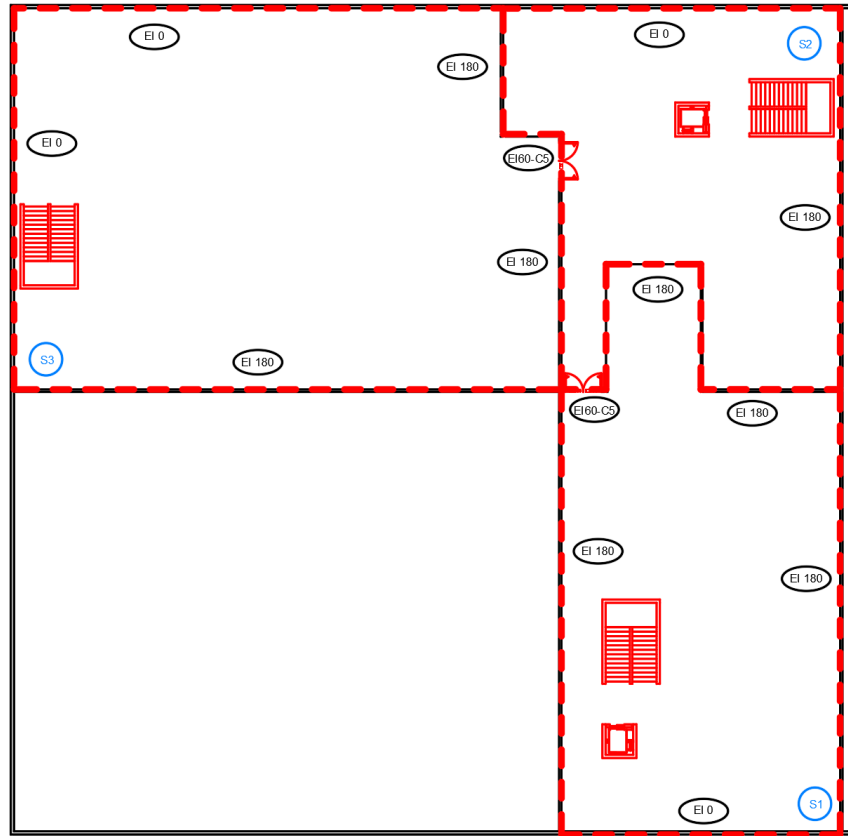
Resistencia al fuego de los cerramientos de proyecto para la primera planta
